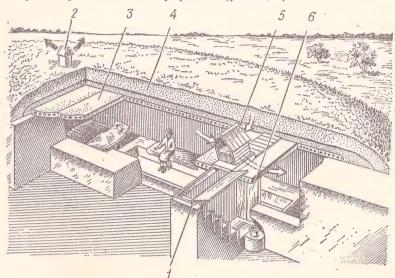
Противорадиационное укрытие с перекрытием из железобетонных плит:
